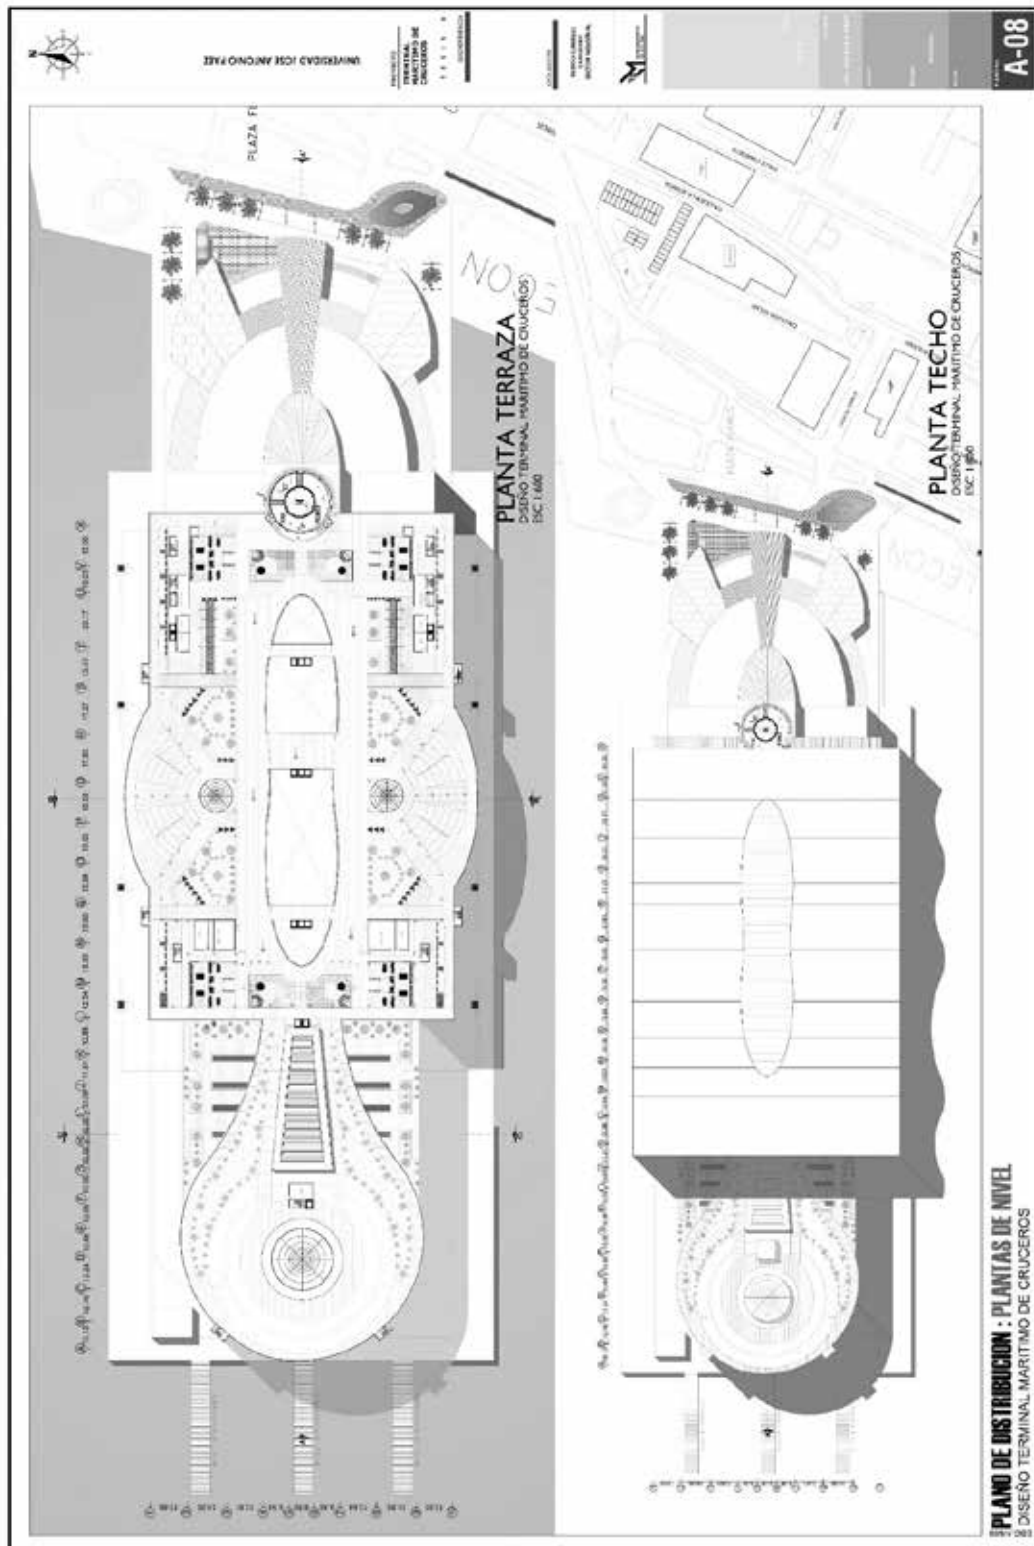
Plano de planta terraza y planta techo (Nivel +25.75)
